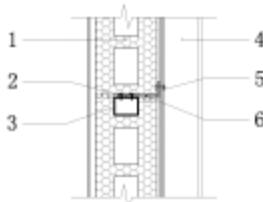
墙体水平芯肋与结构柱连接组合构造示意
